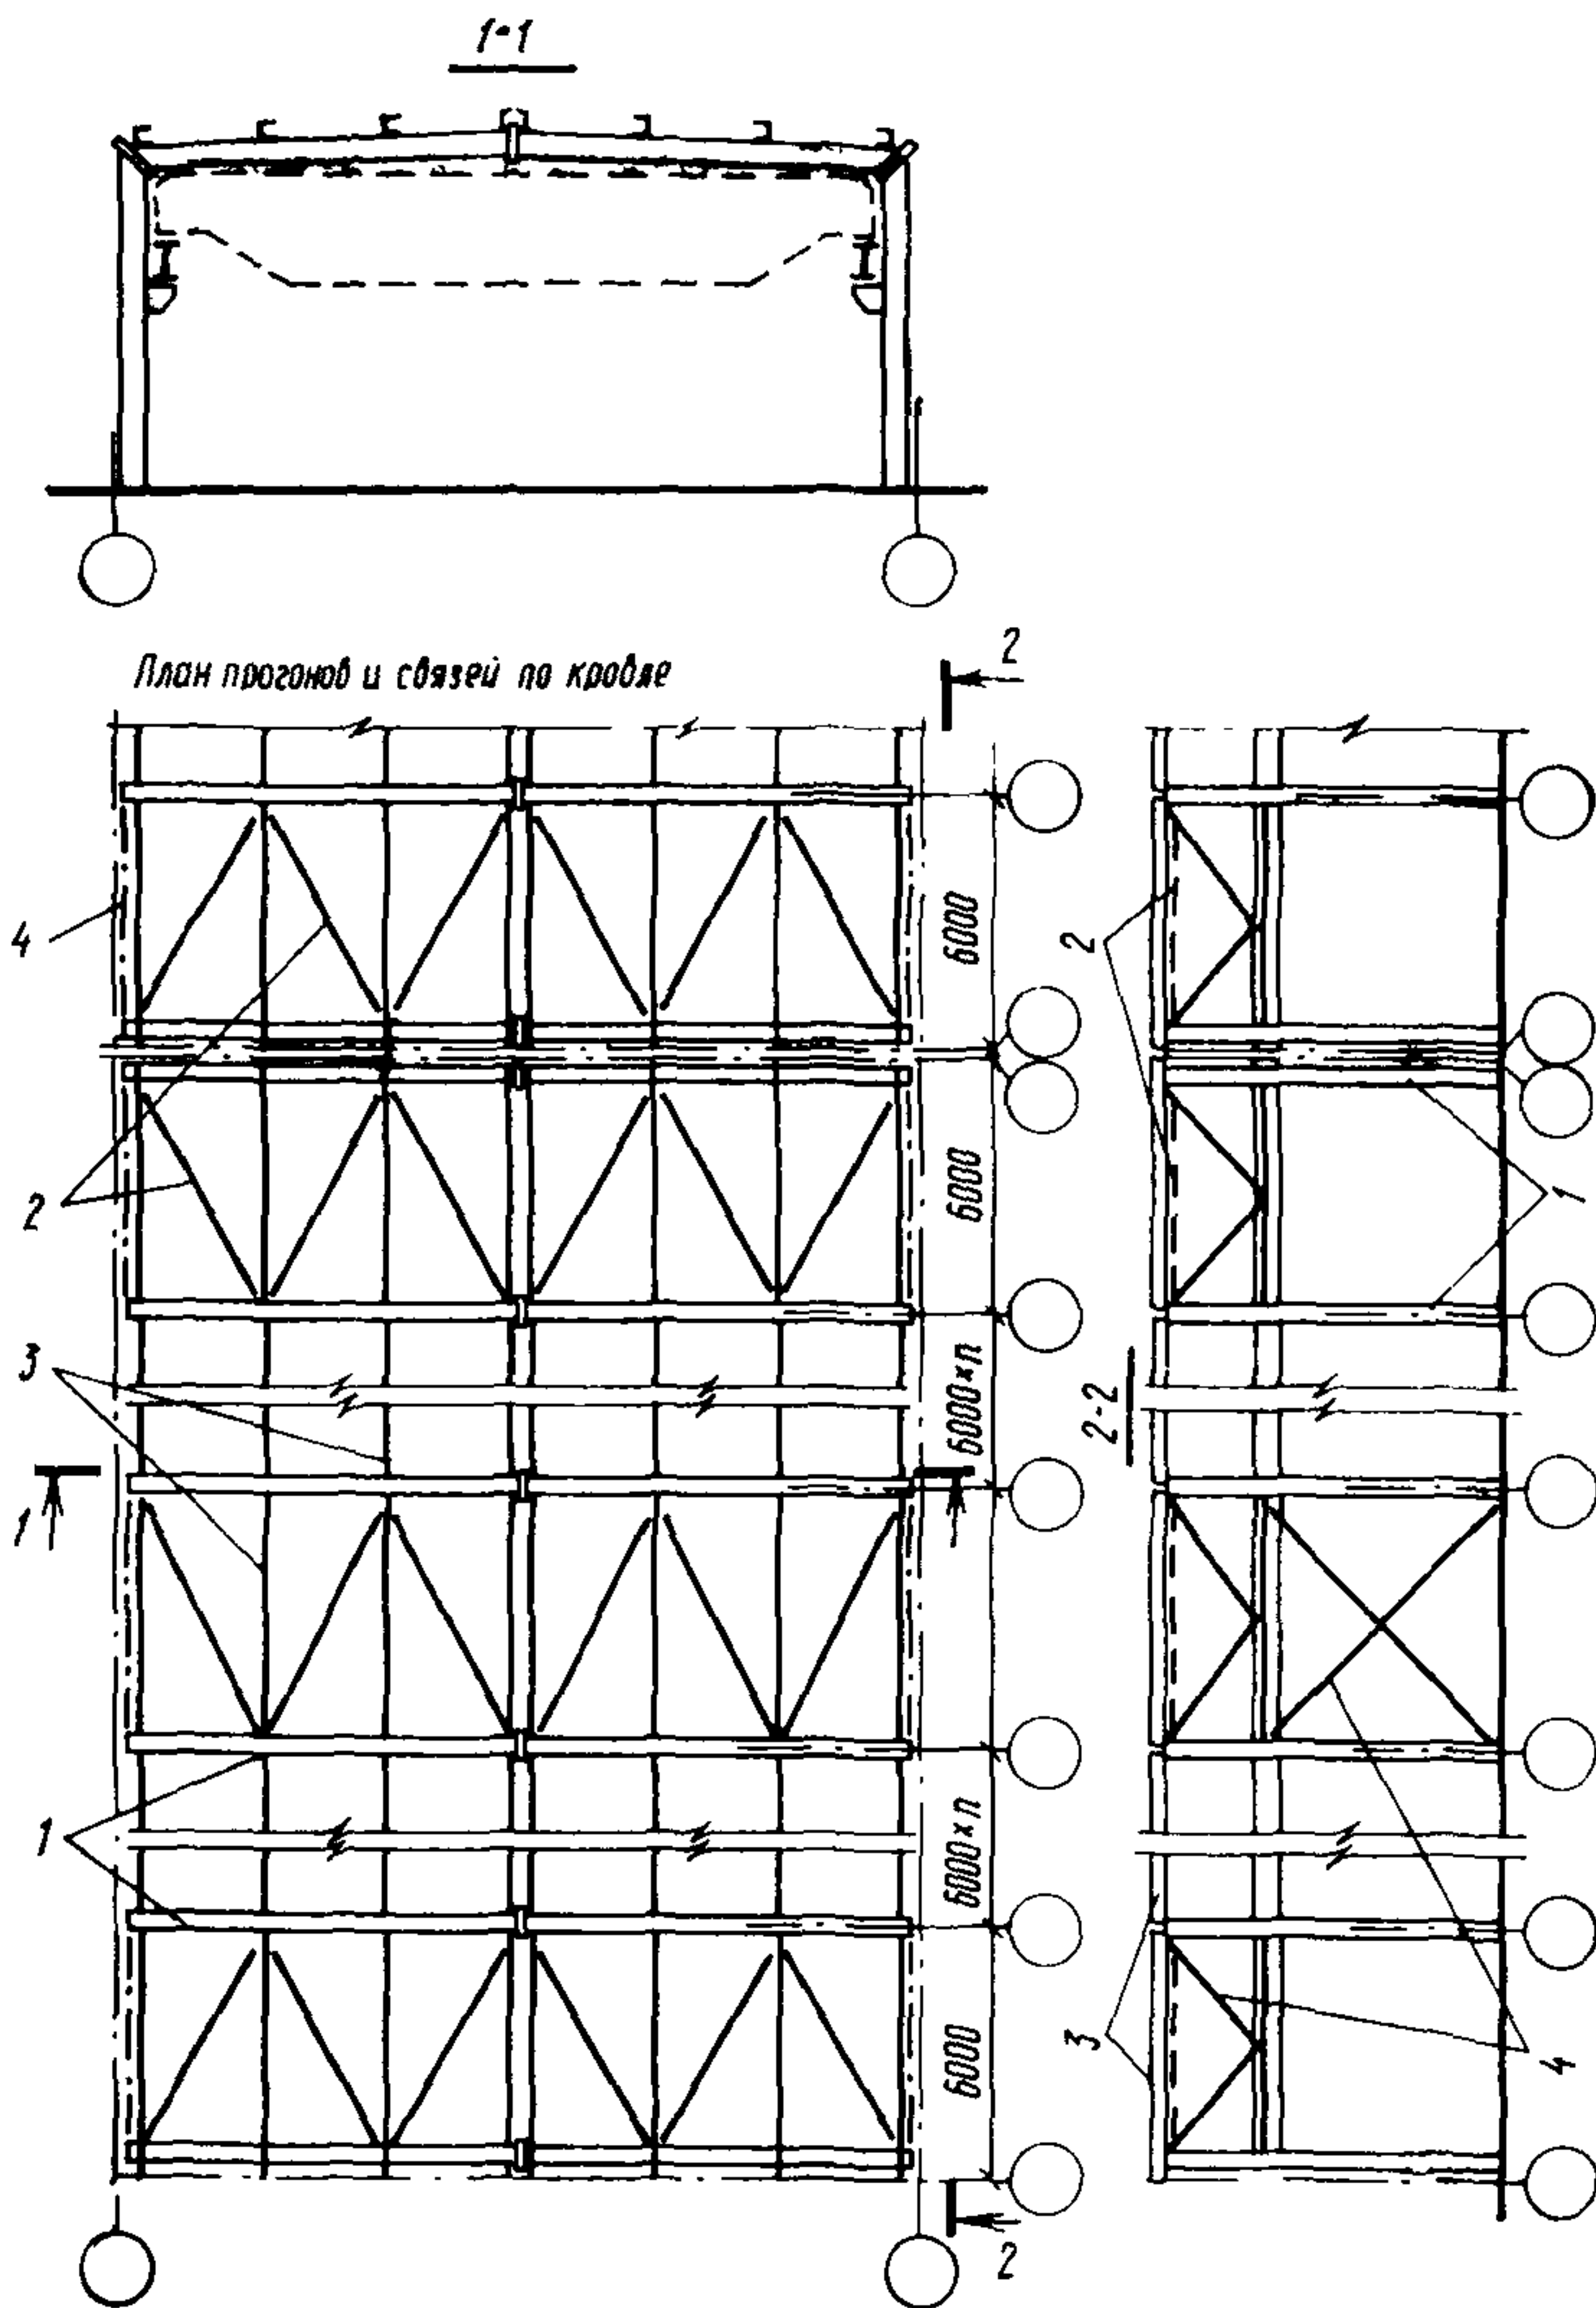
Пример решения одноэтажного здания из стальных конструкций типа «Плауэн»
